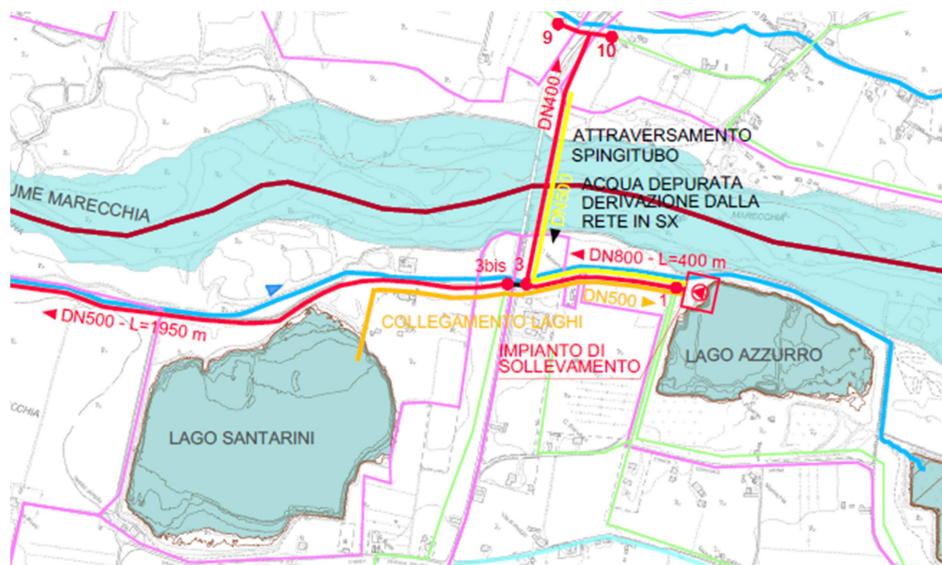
Planimetria di progetto con individuazione dell'impianto di sollevamento
